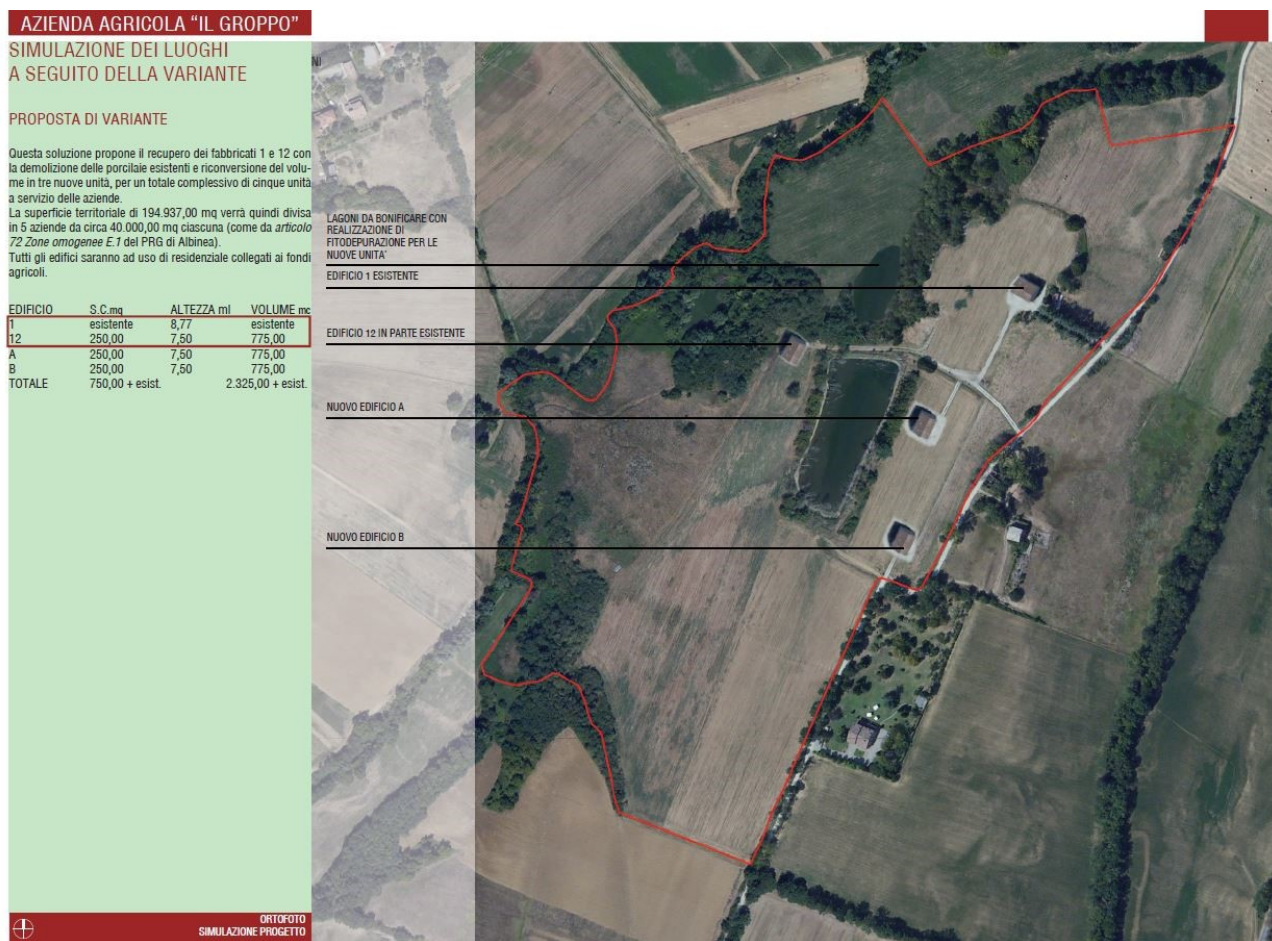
Estratto Planimetria intervento (da Allegato B: Elaborato planivolumetrico e concept dell'Intervento)
